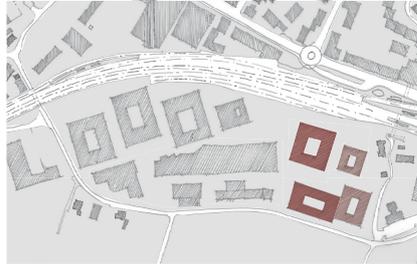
Variante «Zwilling» mit Ersatzbauten orientiert am LANDI-Laden, 2. Workshop, April 2023
